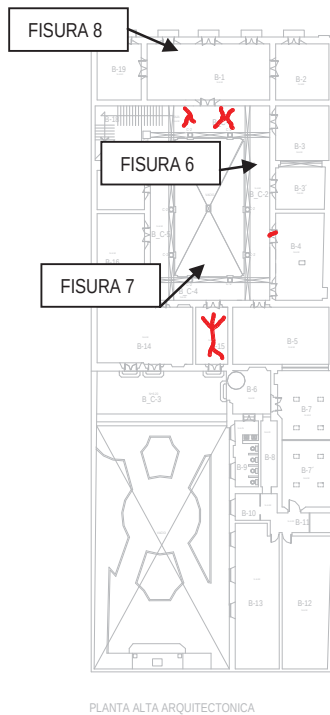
fisuras en pisos del pasillo sur, planta alta y corredor norte.
